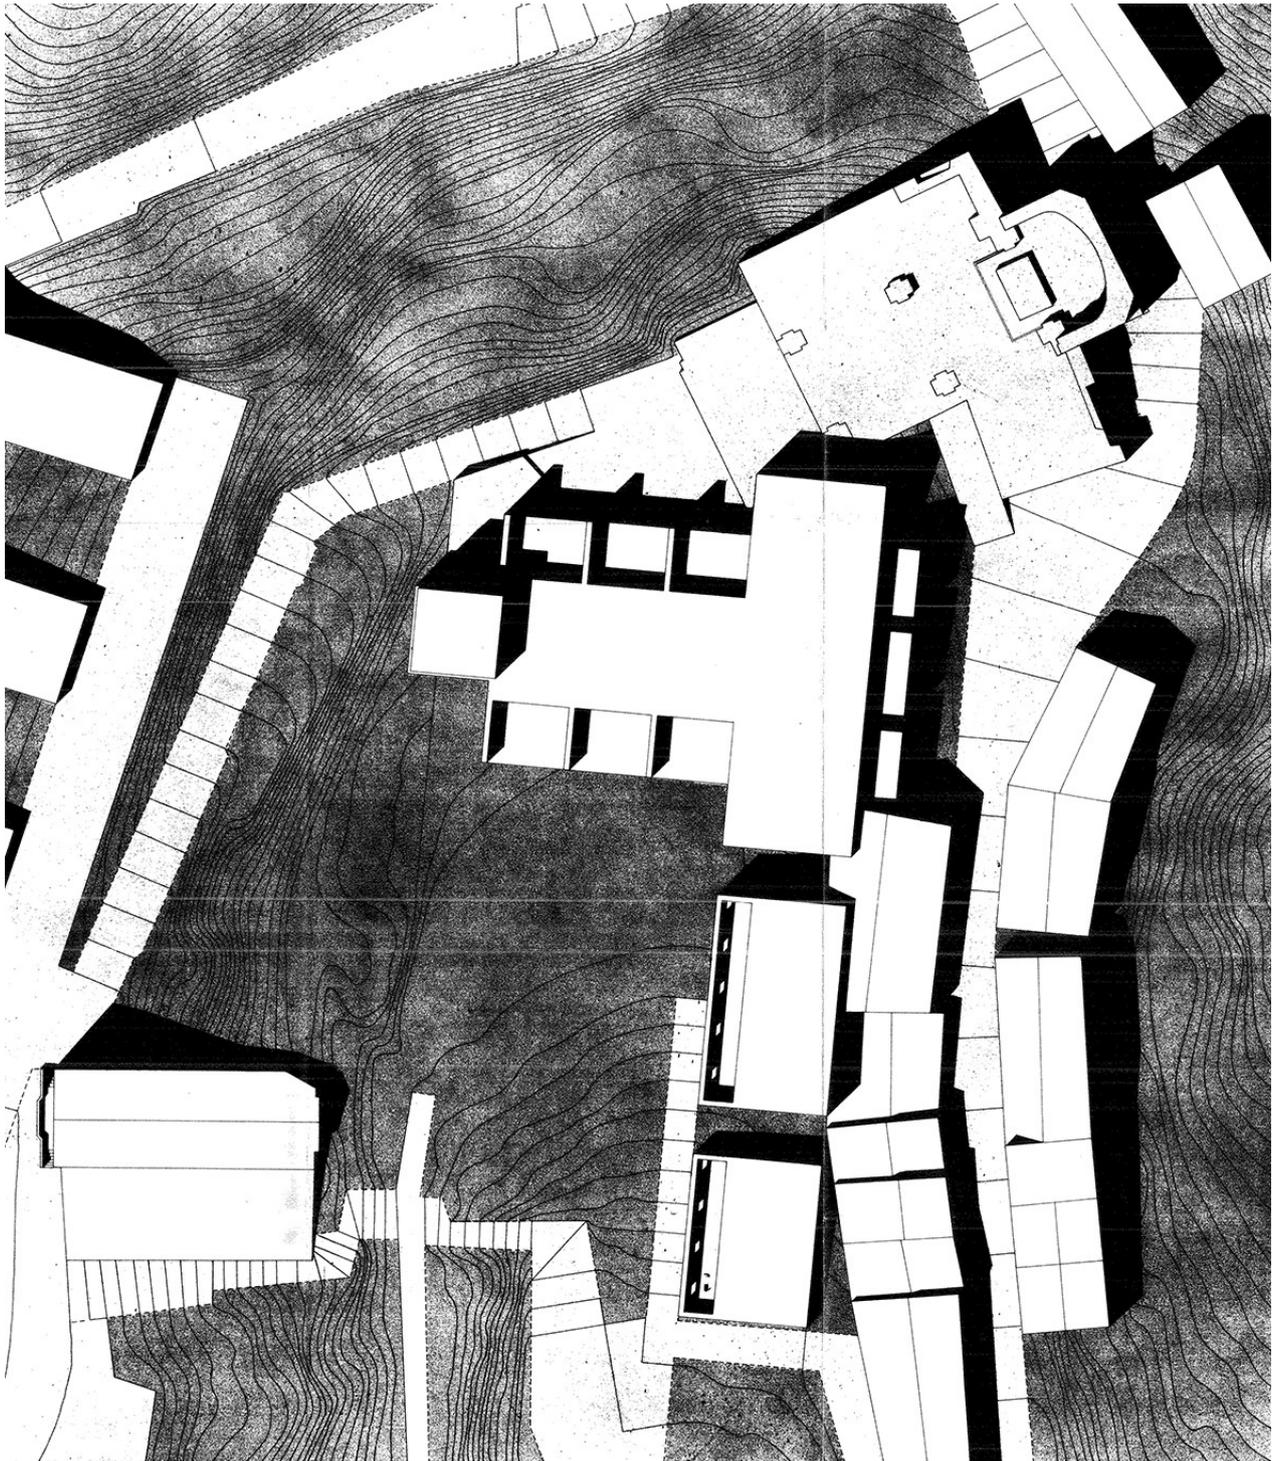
Piano di Recupero di Teora: progetto della Chiesa Madre (planivolumetrico)
